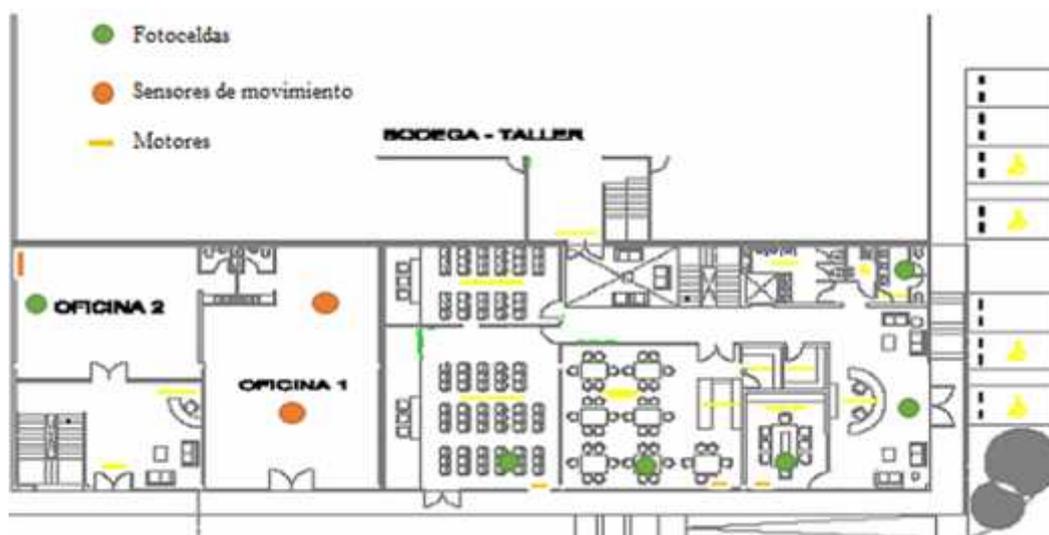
Subsistema de Iluminación en la Planta Baja del Área Comercial
